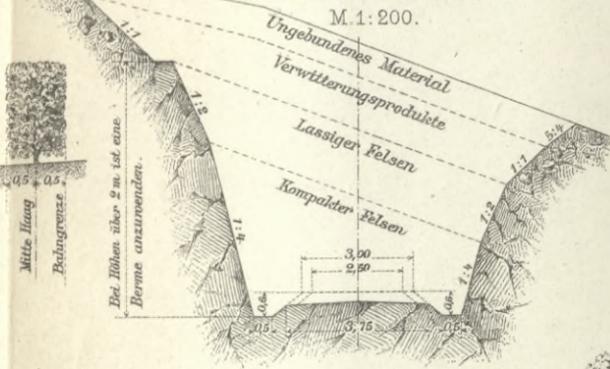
Bahnkörper der Ocholt-Westerstede-Eisenbahn.
